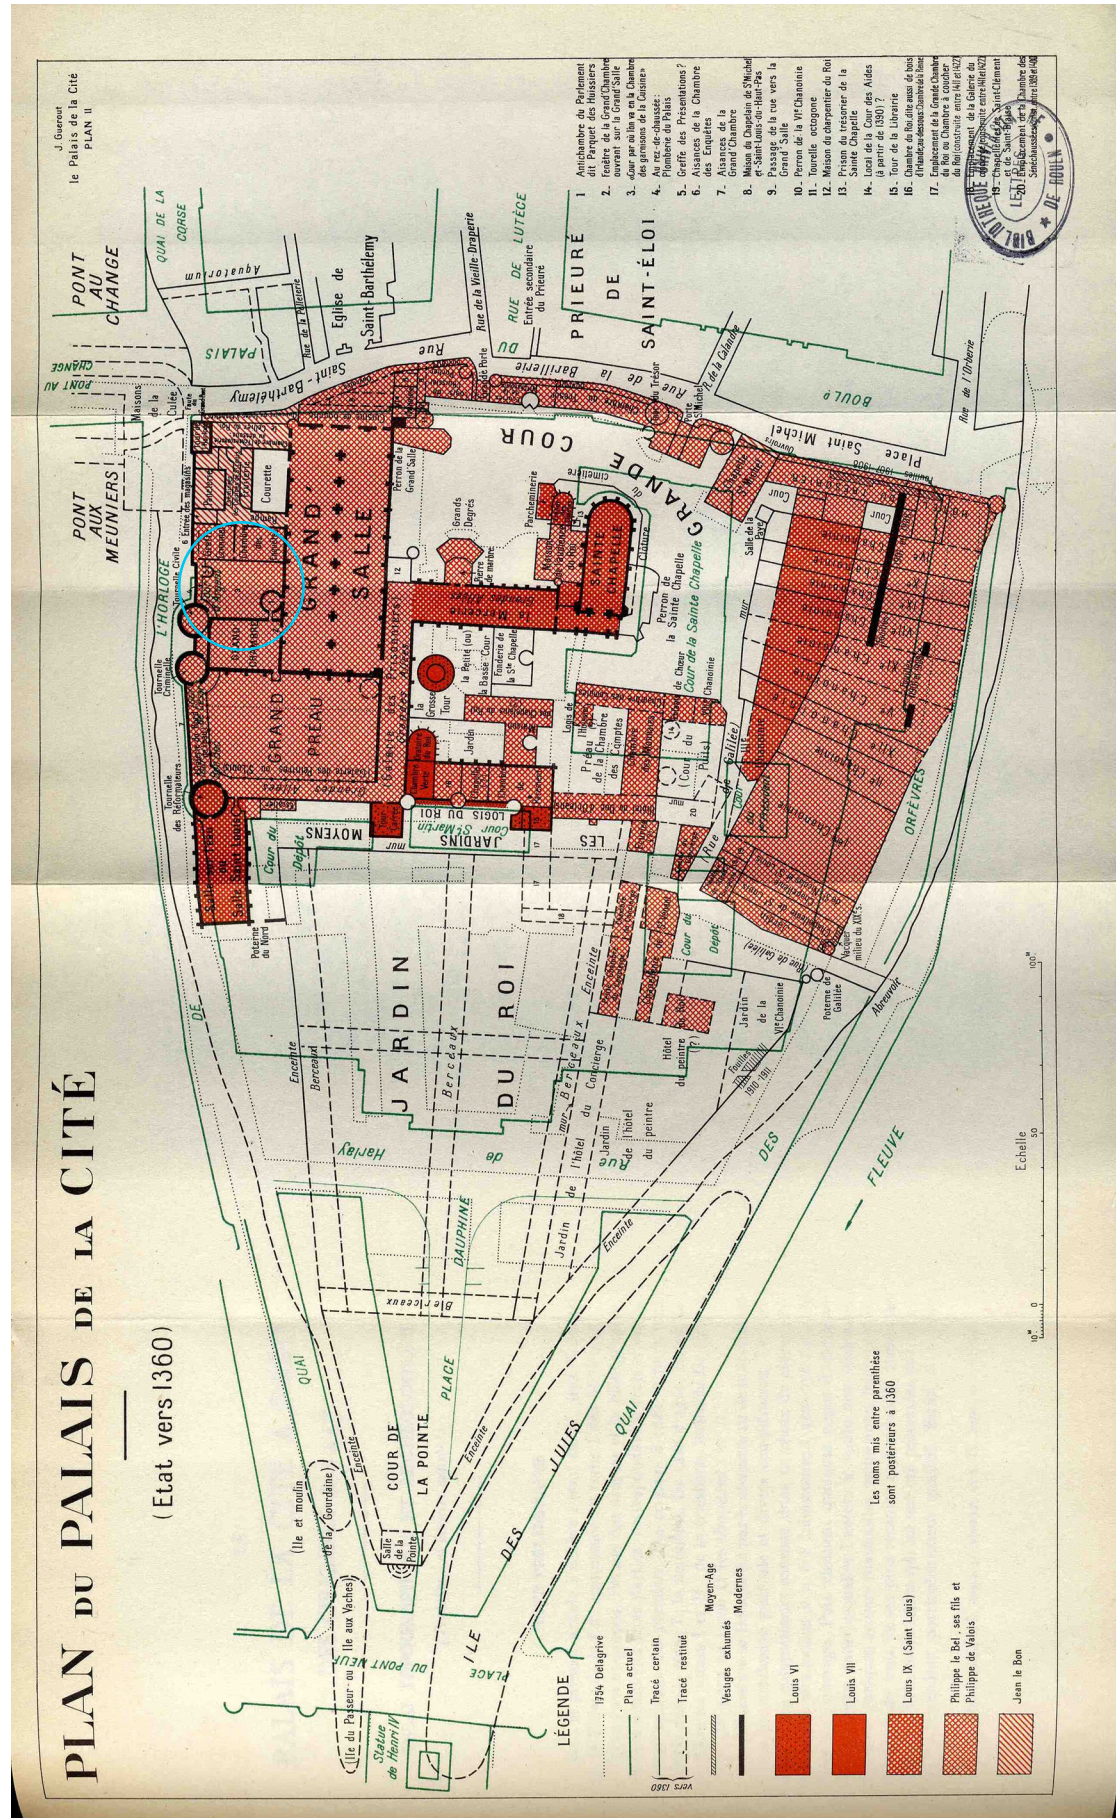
Plan du Palais de la Cité (état vers 1360) (Guérout 1953).
